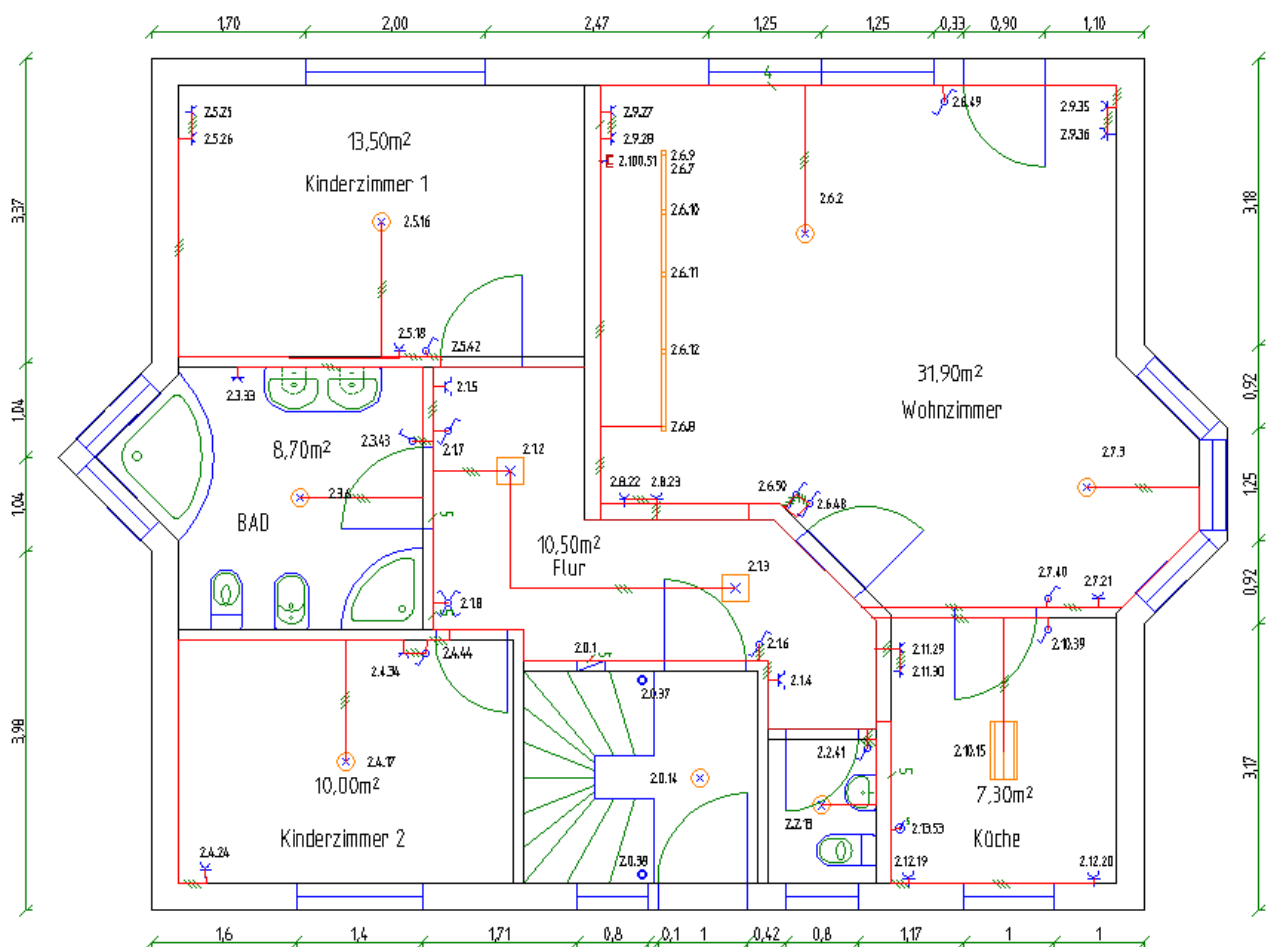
Fertig projektierter Elektroinstallationsplan (Grundriss eines Einfamilienhauses)
